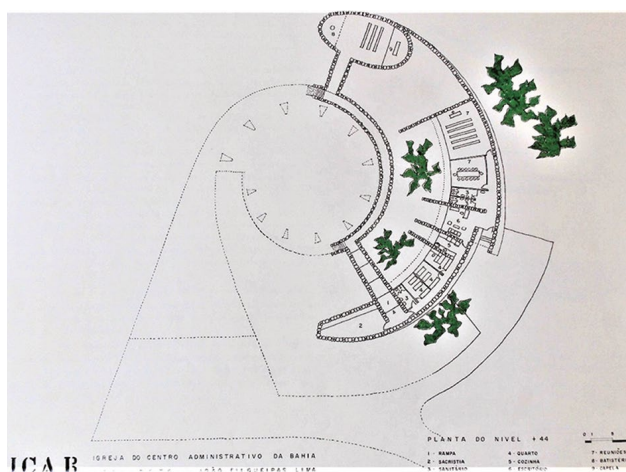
Planta baixa, nível subsolo. 1973.⁶⁵
